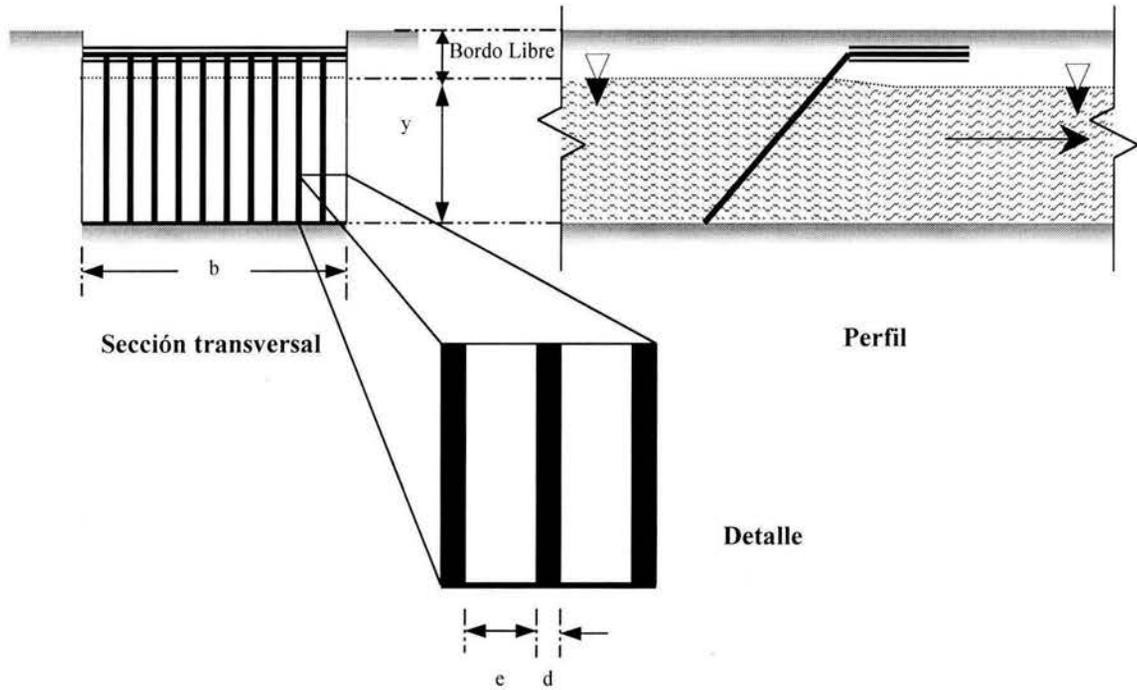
Sección transversal, detalle y perfil de un Canal de Rejillas
